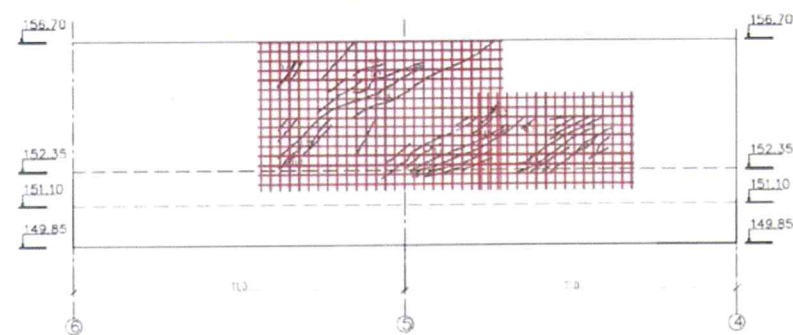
Усиление напорной стены здания ГЭС
